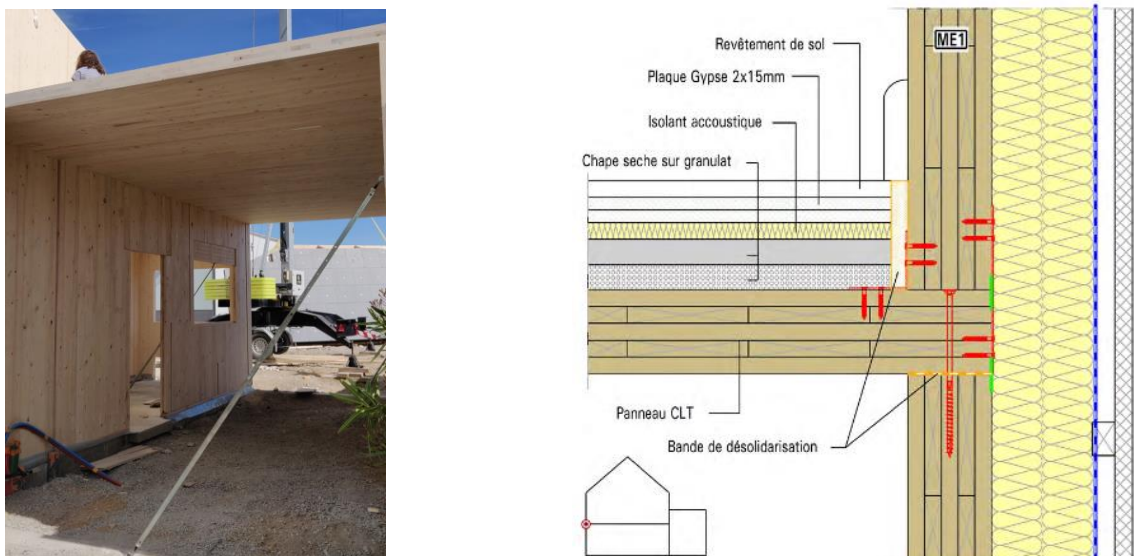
Pose et fixation du plancher, source C. Launeau et [45]
